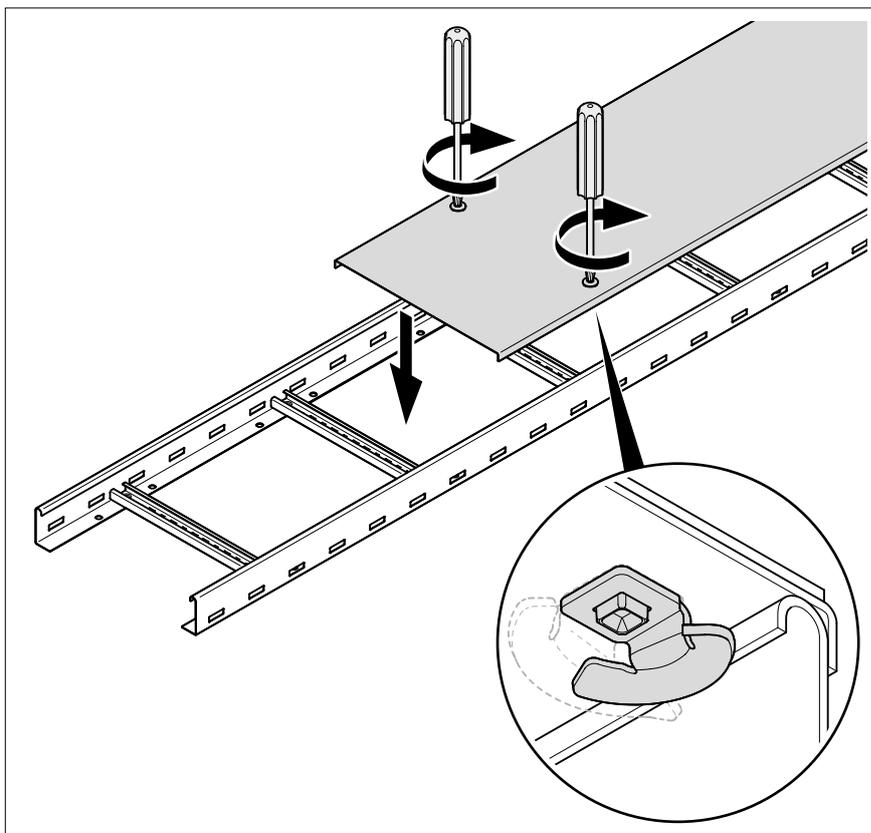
Монтаж крышки с поворотными фиксаторами
